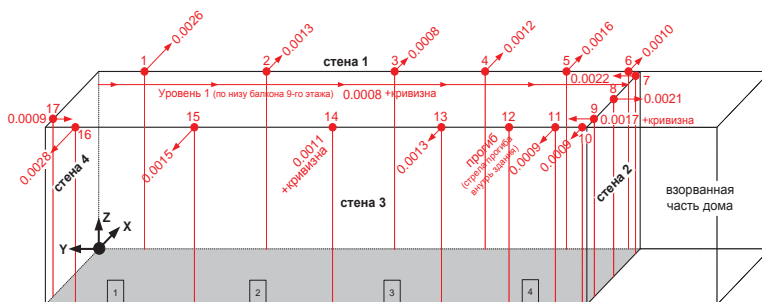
Схема геодезических наблюдений за кренами стен здания в 2023 году
